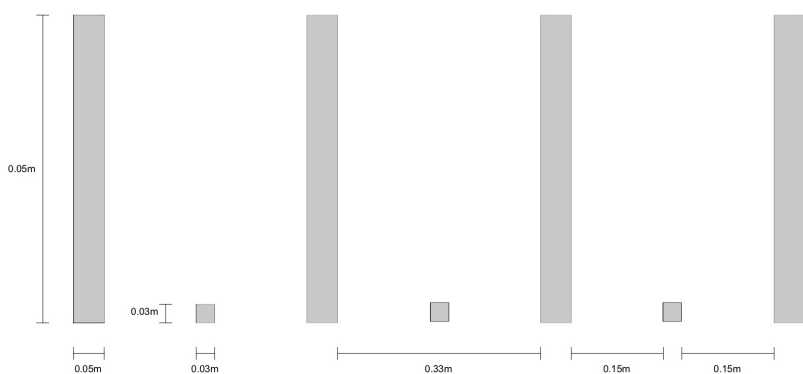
Desenho em planta com dimensões do gradeamento. Fonte:Elaboração própria.
